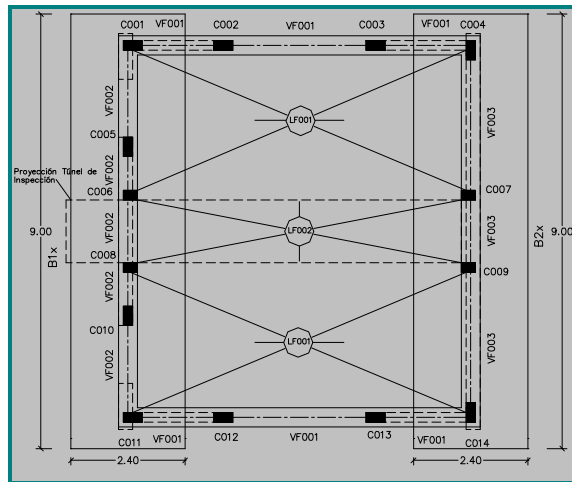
Planta de estructura tipo del edificio de dormitorios.
